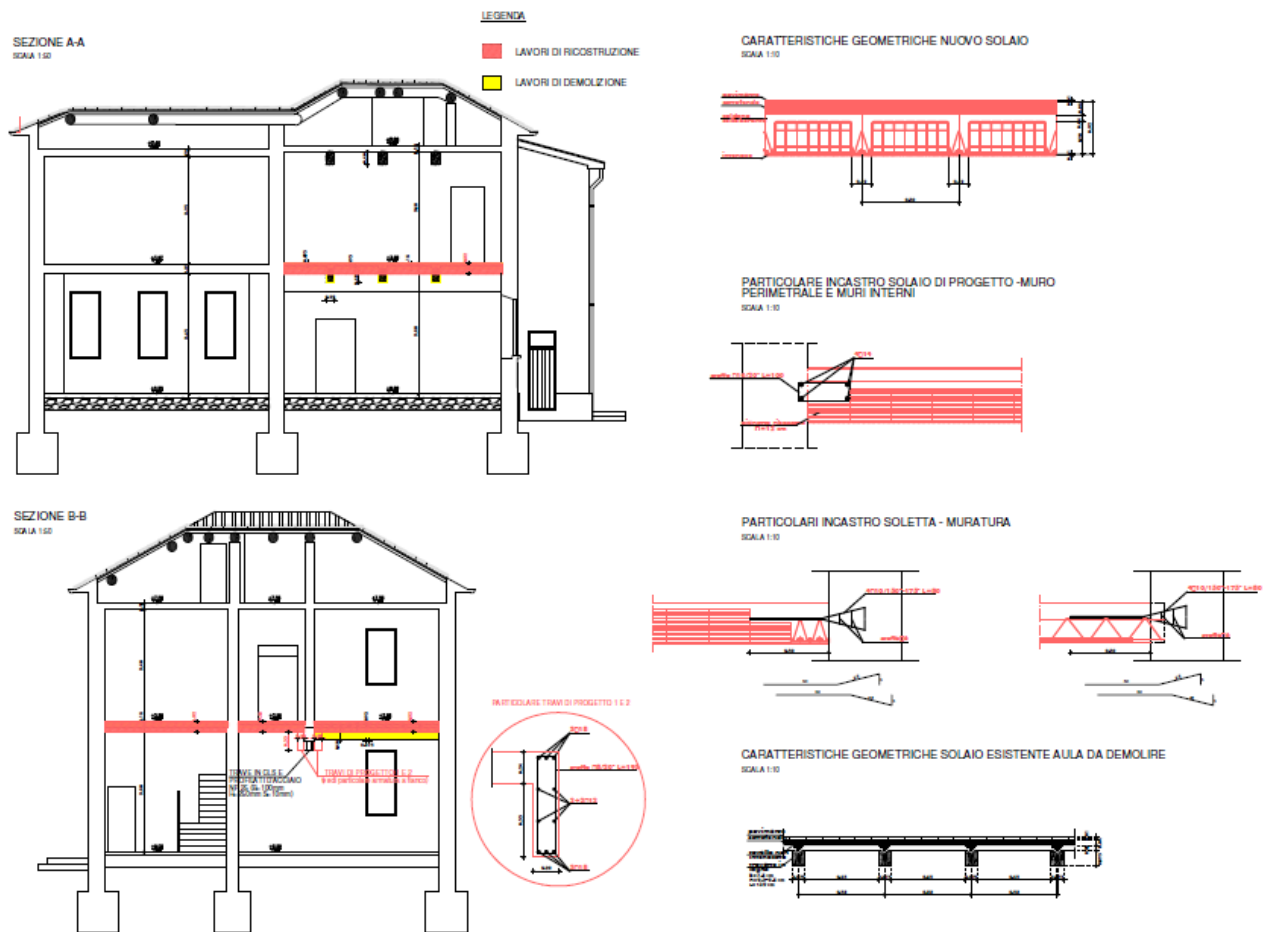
Stralcio progetto esecutivo sostituzione porzione I solaio ligneo con nuovo in latero-cemento.
